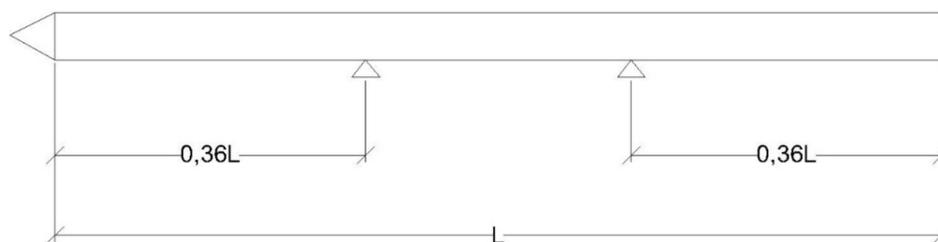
Схема испытания свай на раскрытие трещин
